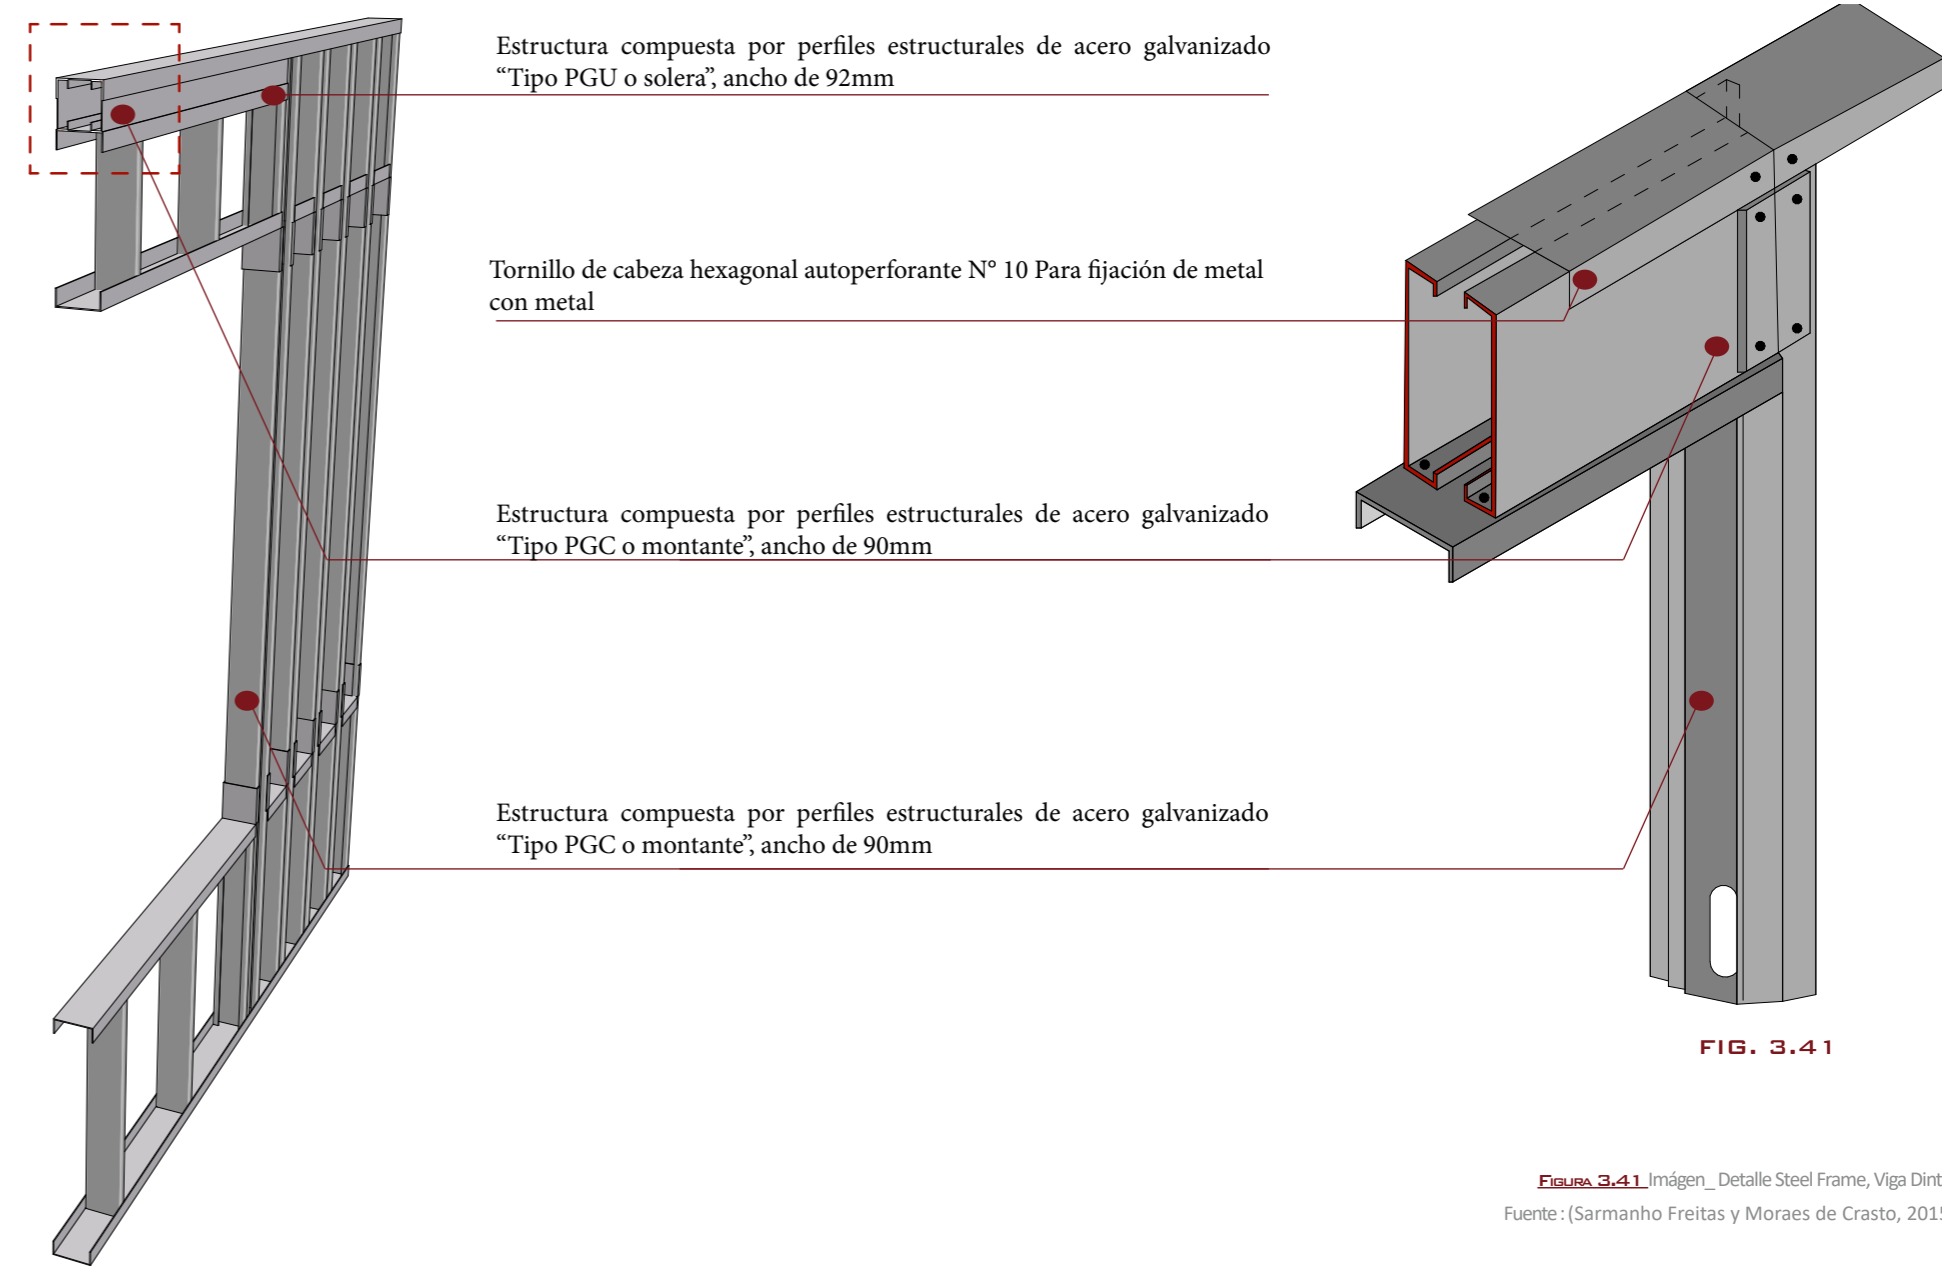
Imágen_ Detalle Steel Frame, Viga Dintel
